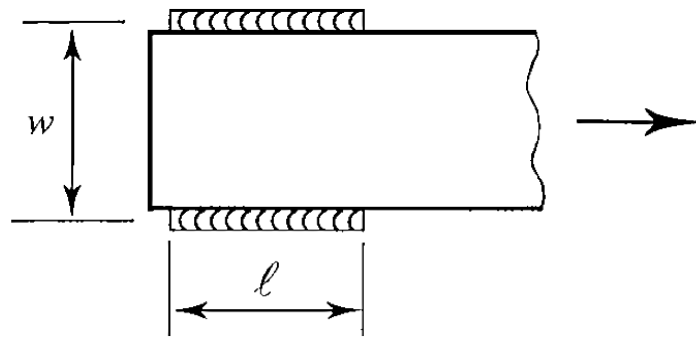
Placa de acero soldada longitudinalmente en ambos lados sin utilizar soldadura transversal
